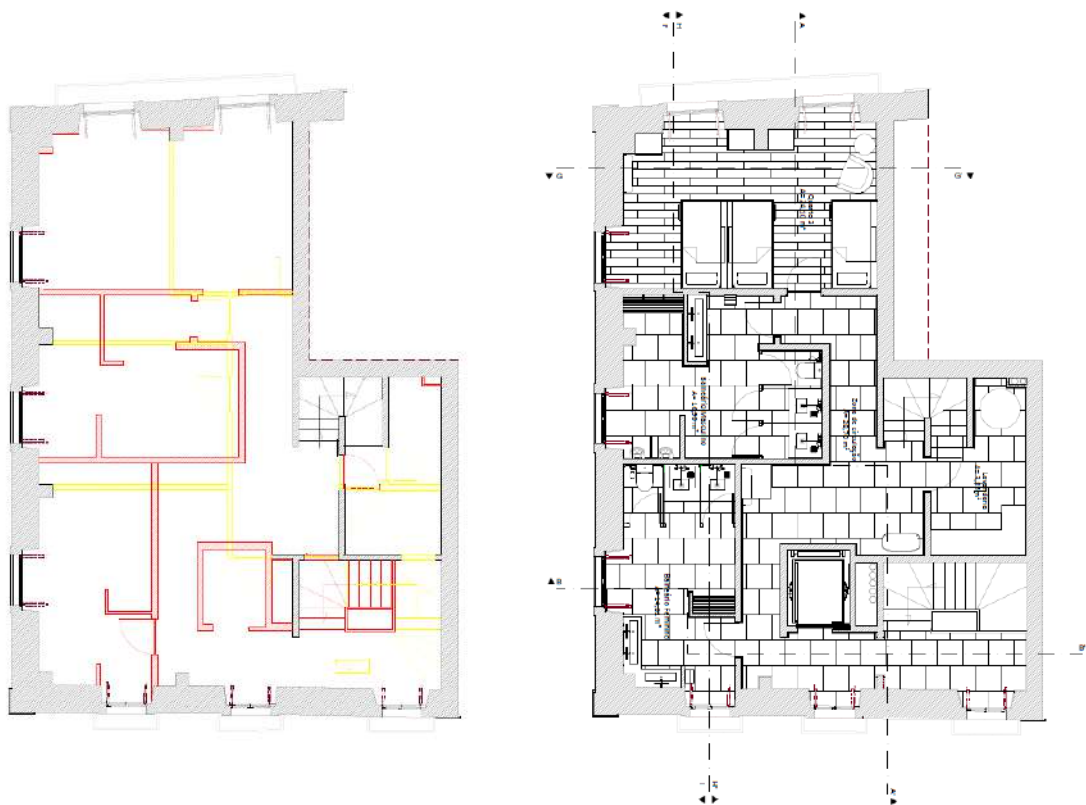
Planta de Alterações e Planta de Apresentação (Piso 2)
